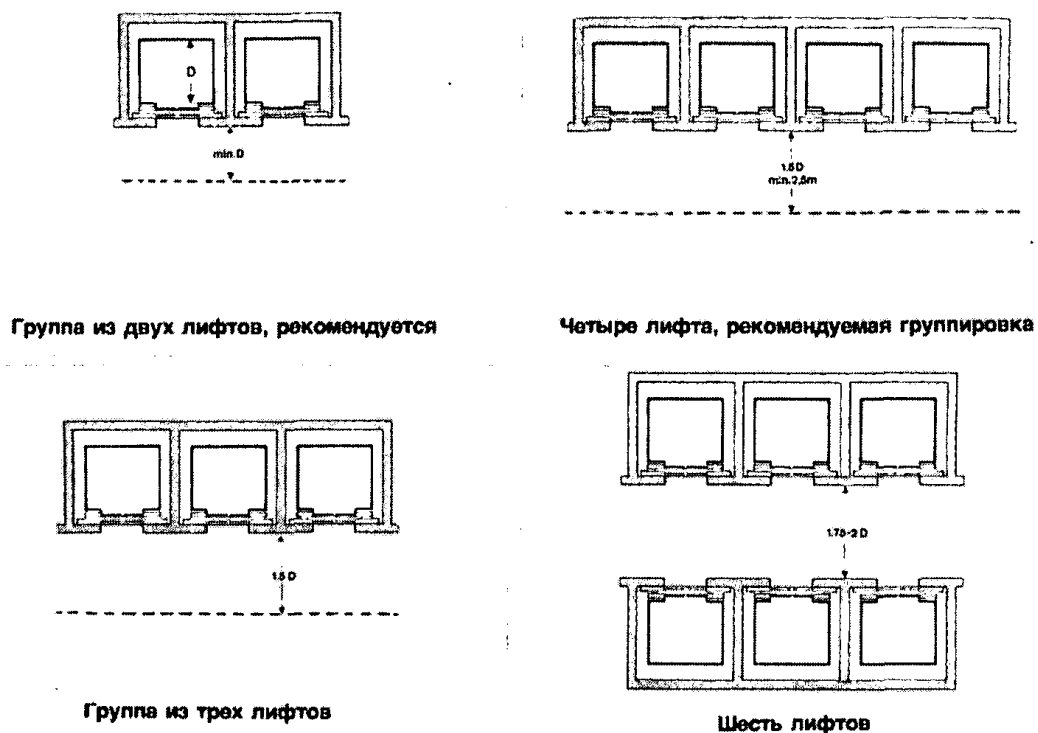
Типовые схемы размещения лифтов в плане здания, где B - глубина кабины
